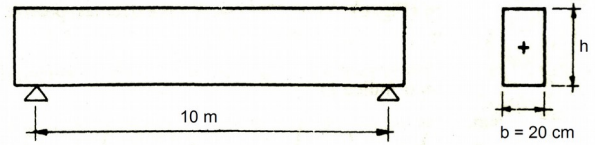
Viga simplesmente apoiada, submetida à protensão por cabo reto excêntrico.
